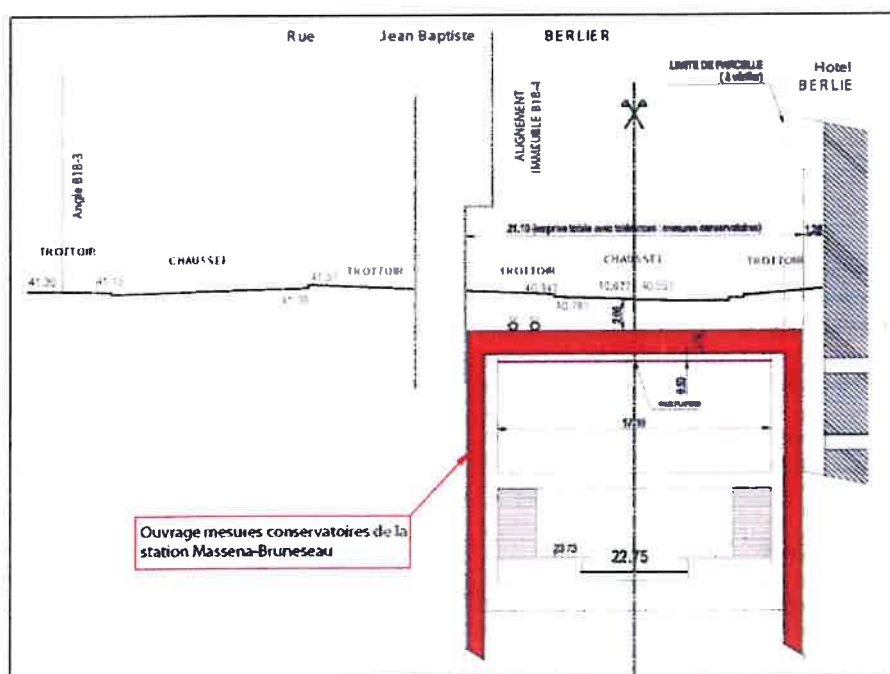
Coupe sur l'ouvrage Berlier (Etudes mesures conservatoires AVP, SEMAPA, 2011)
